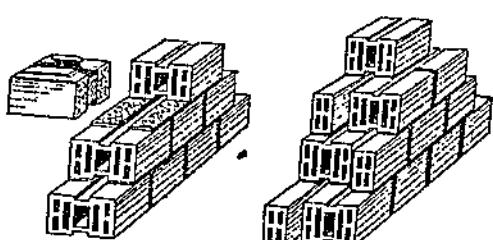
Кладка стены из блоков, образующих воздушные каналы в горизонтальных швах.
